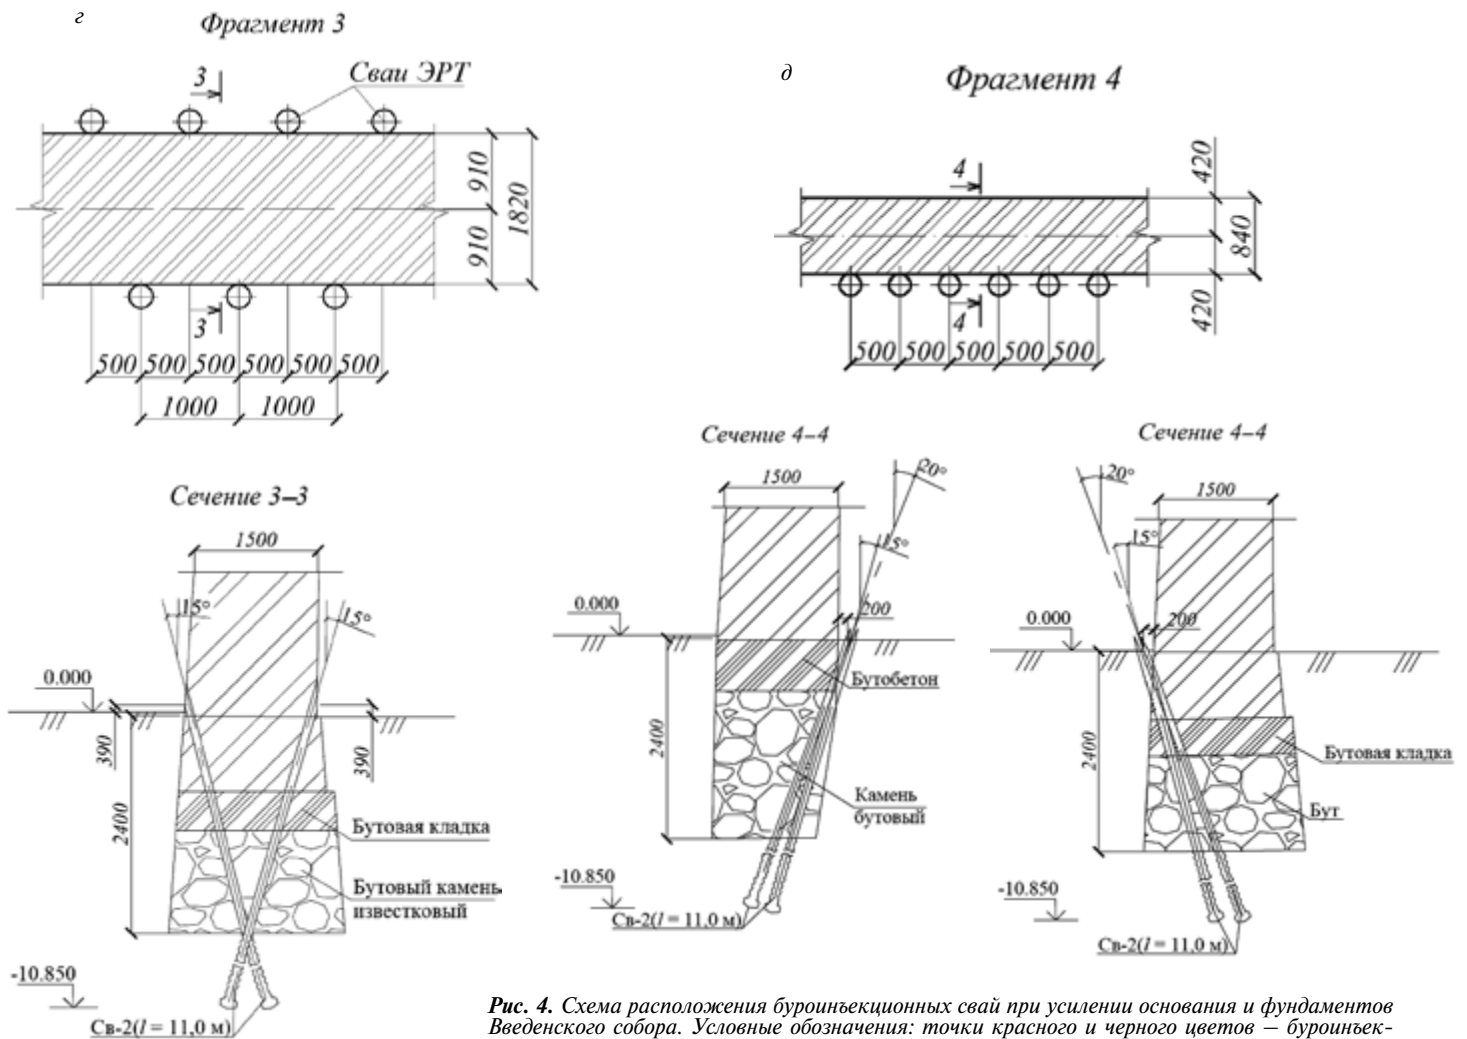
Схема расположения буринъекционных свай при усилении основания и фундаментов Введенского собора. Условные обозначения: точки красного и черного цветов – буринъекционные сваи усиления основания и фундамента; точки зеленого цвета – буринъекционные сваи подпорной стенки с восточной стороны храма; г, д – фрагменты с сечениями 3–3, 4–4
